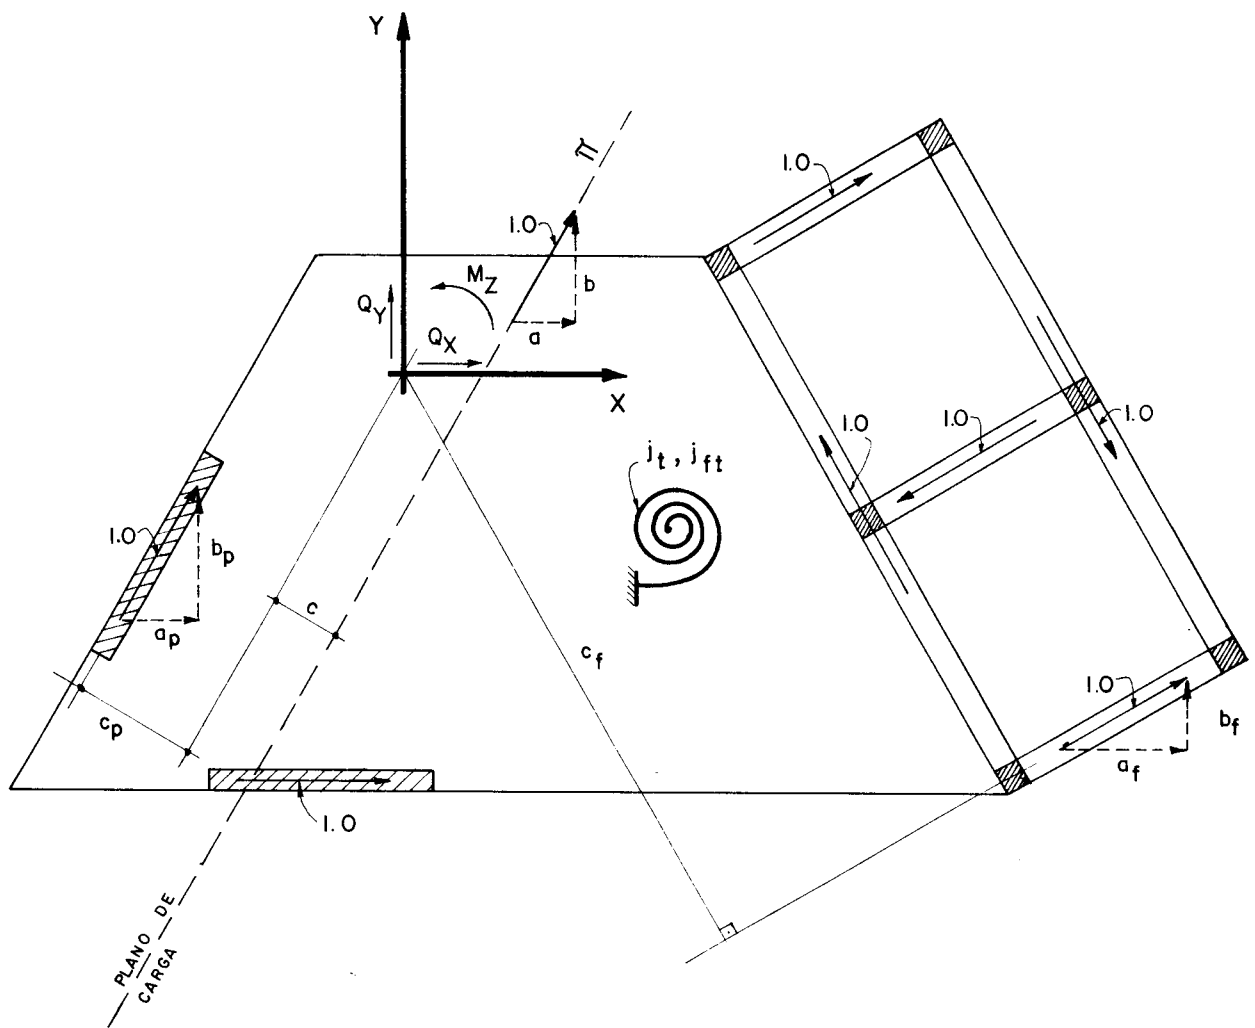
PLANTA DA ASSOCIAÇÃO GERAL DE TIPOS BÁSICOS DE PAINÉIS DE CONTRAVENTAMENTO.
